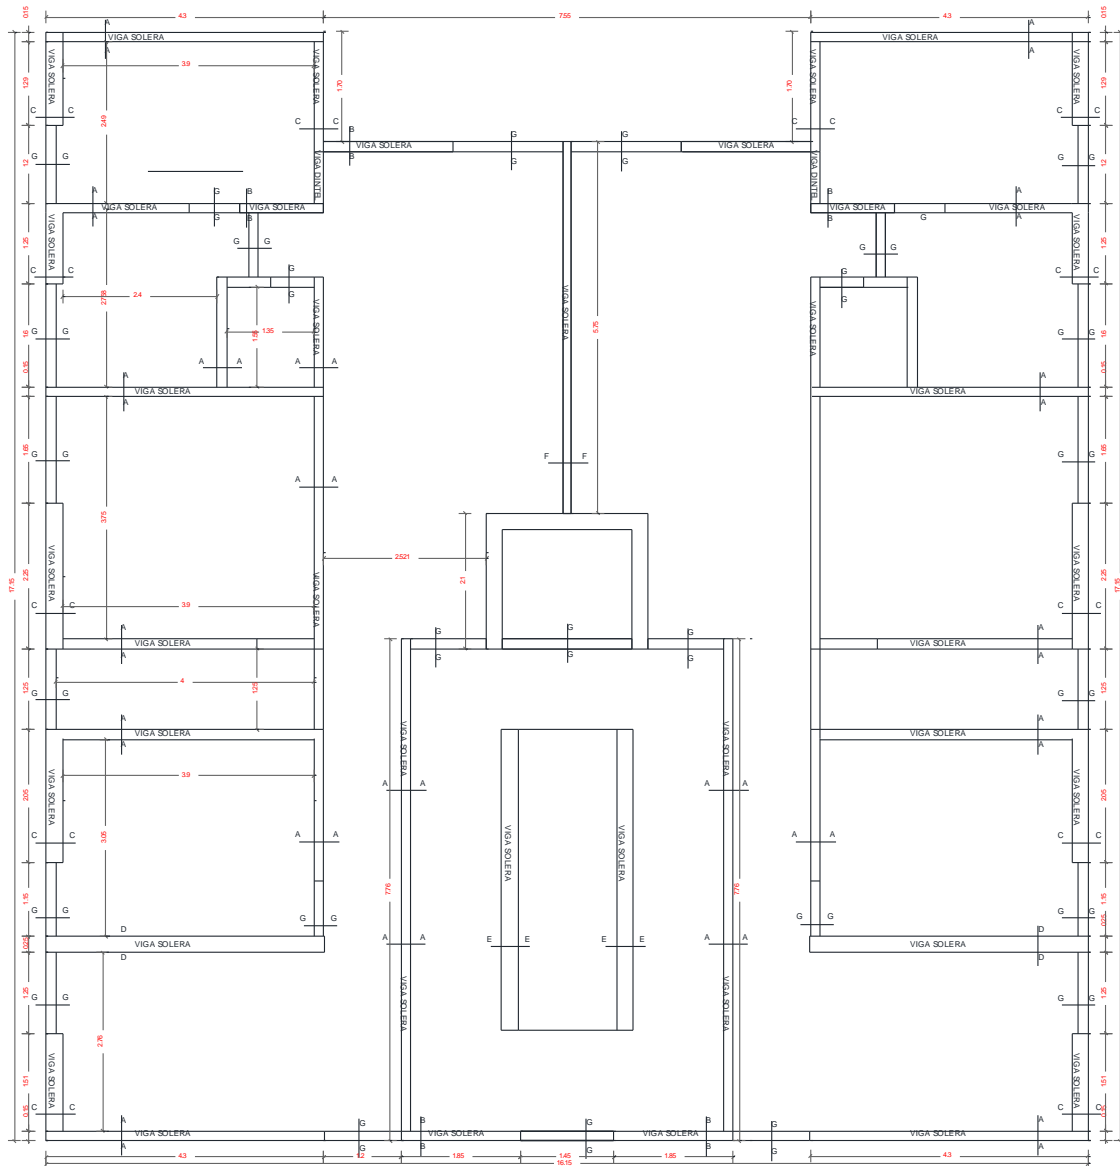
Plano de dimensiones de paños para diseño de losa maciza
